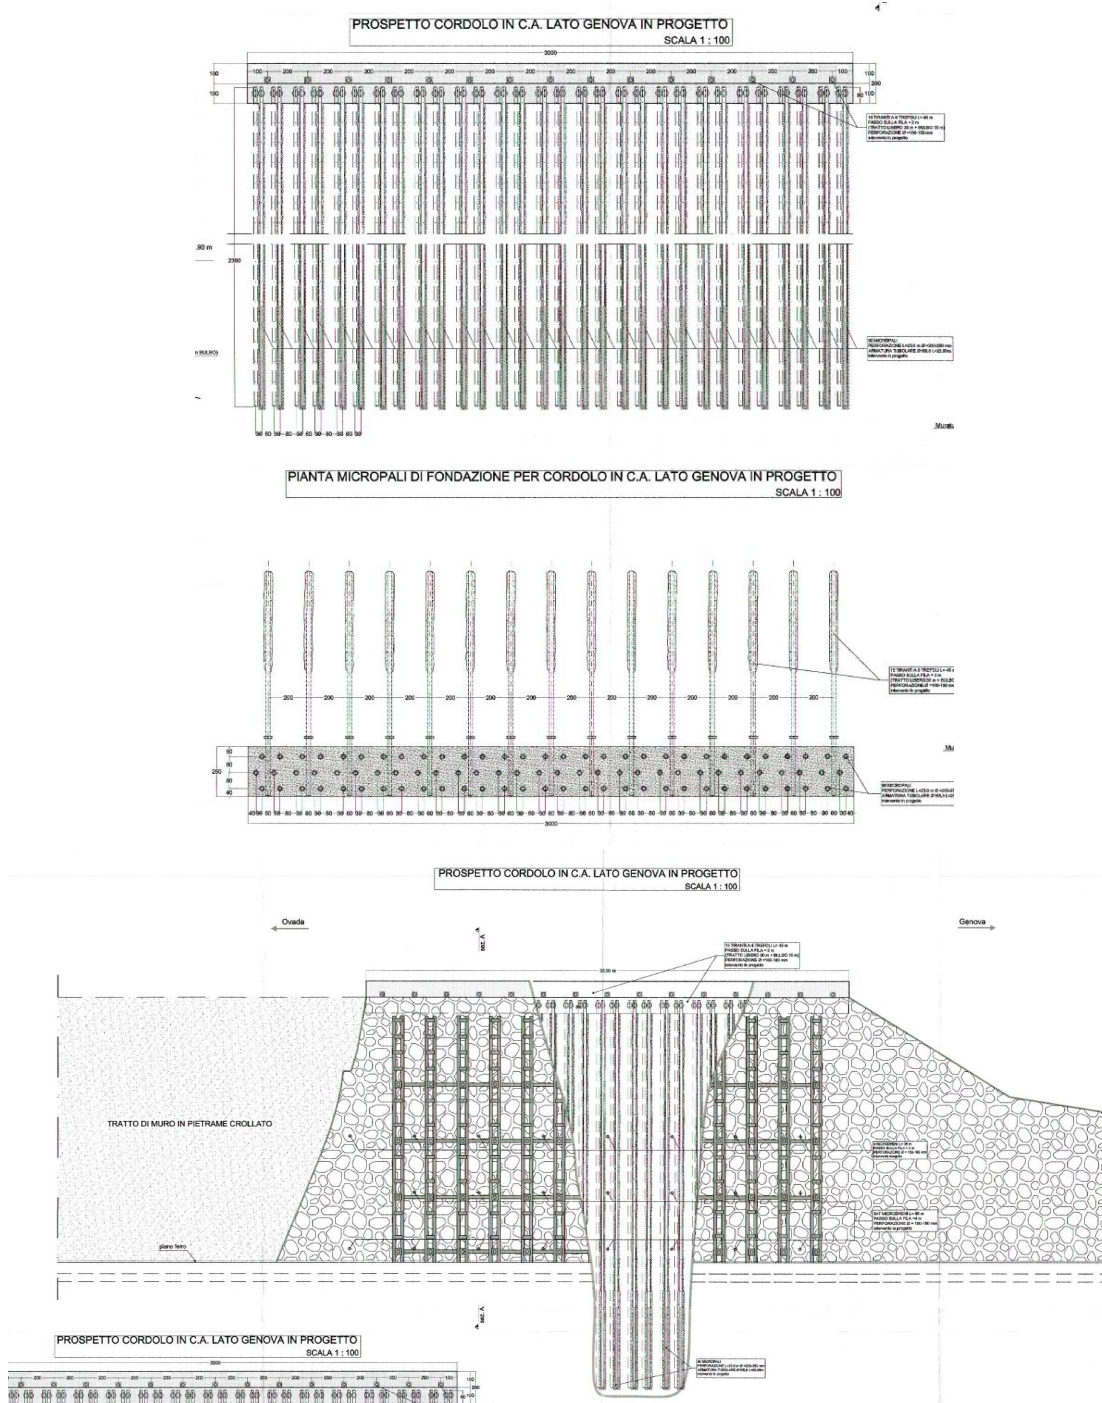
Stralcio degli interventi realizzati di consolidamento del muro in muratura lato Genova.
